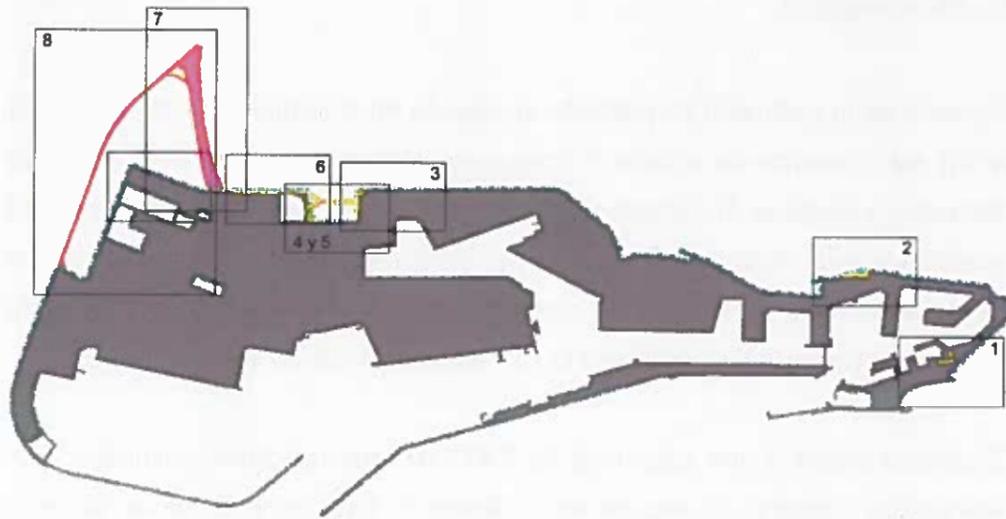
Plano de planta general en el que se detallan gráficamente las modificaciones objeto de la presente DEUP
